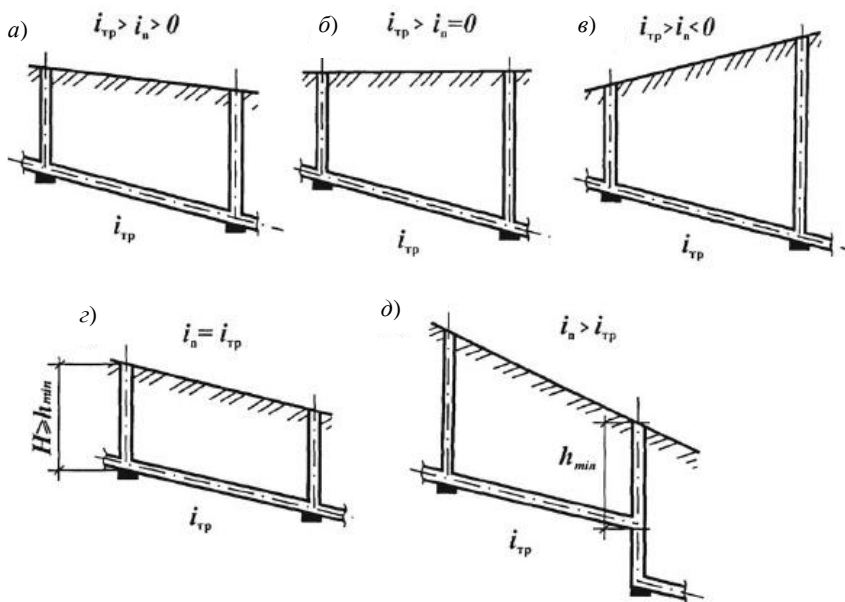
Выбор уклона прокладки трубопровода на расчетных участках при различных уклонах поверхности земли:
